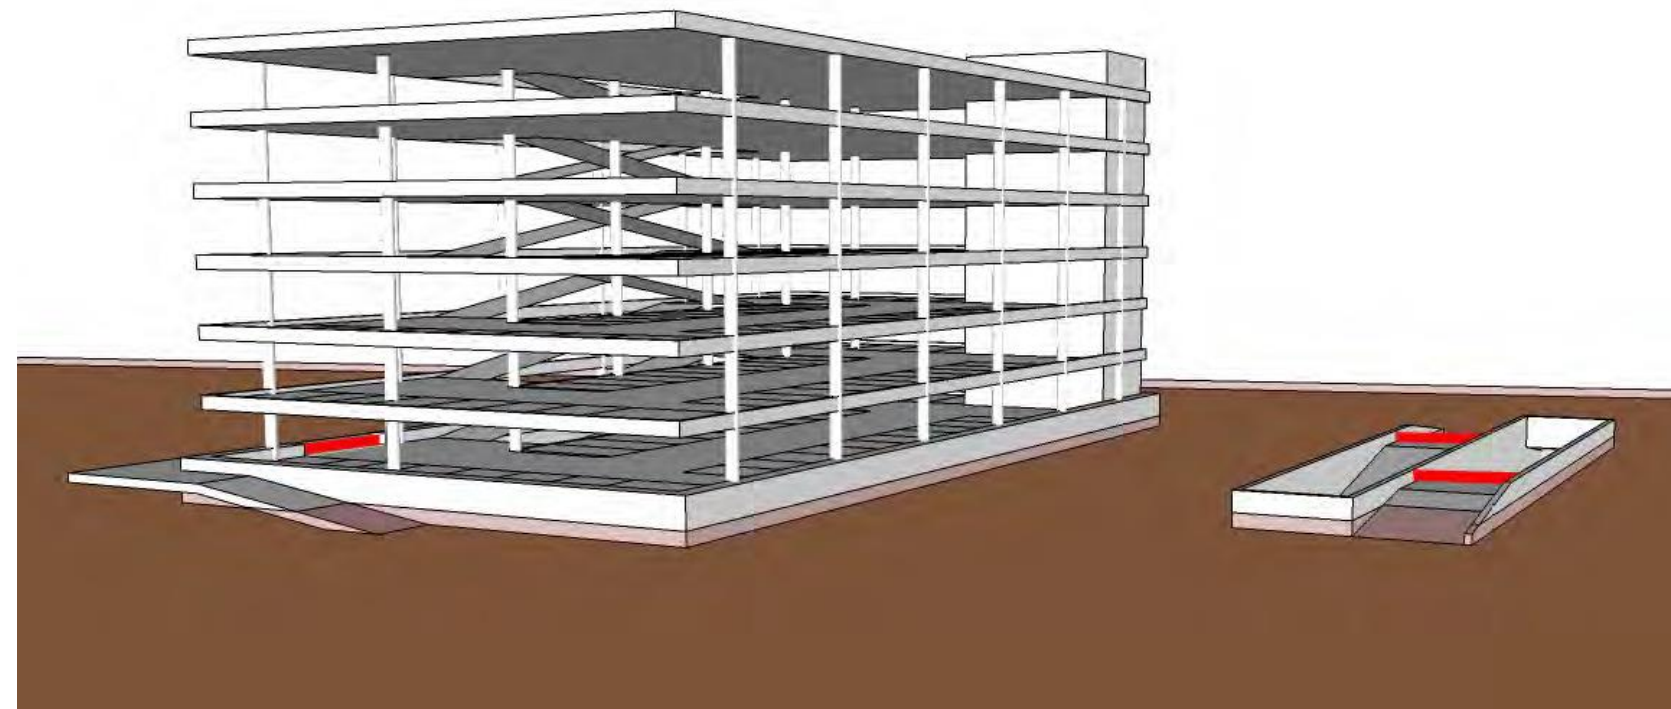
Placement de batardeau aux entrées du parking (Source : AREP)
